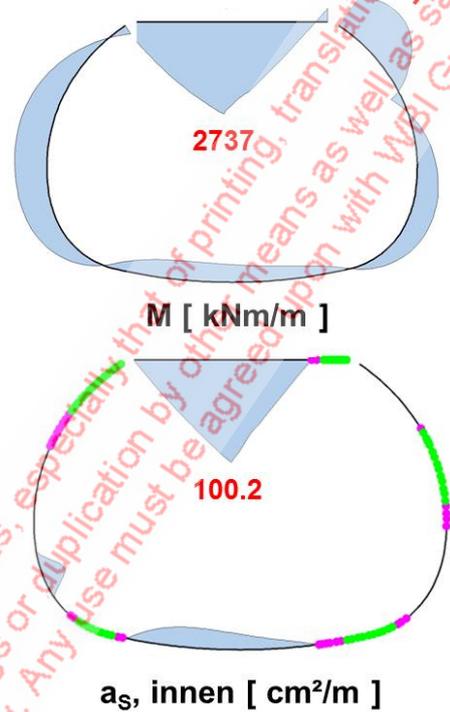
BQ 2, Fall AN, Lastfall EG, Gebirgsdruck und Verkehrslasten, Biegemoment und erforderliche Bewehrung (innen) im S-Bahn-Tunnel
